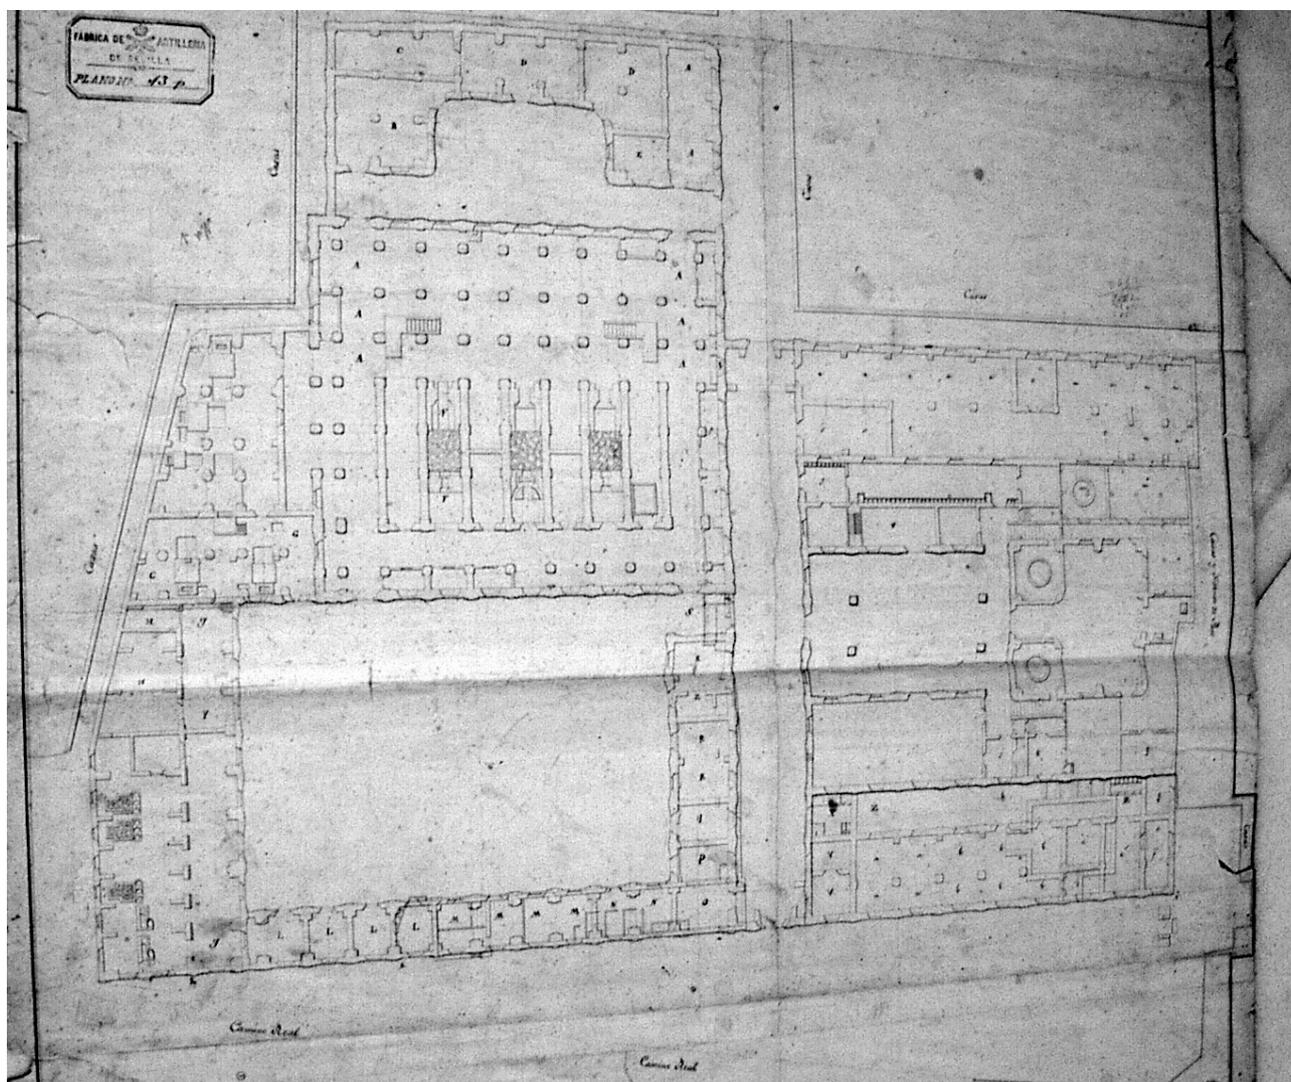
Planta de la Real Fundición hacia 1790. En la parte inferior, la fachada norte. Se pueden observar las dos alas del edificio, este y oeste, separadas por la calle interna que discurre de norte a sur. AFAS. Mapas y Planos.
